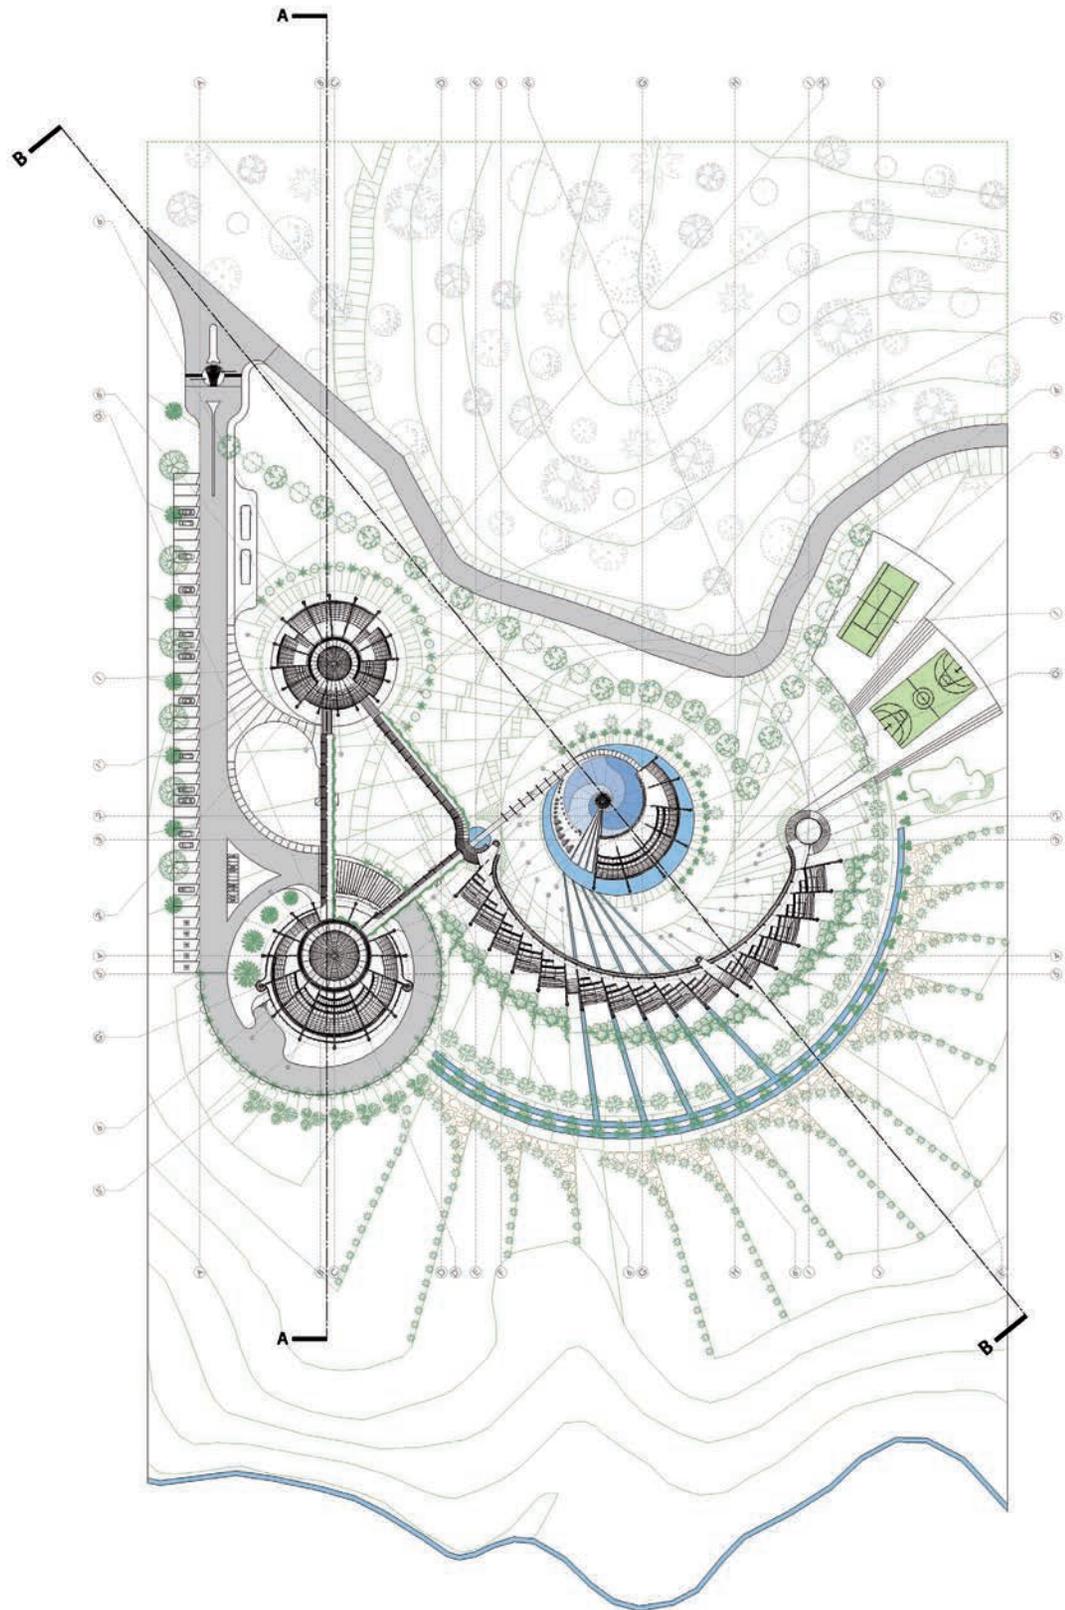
Planta Arquitectónica del Conjunto. Fuente: propuesta personal, 2013.
